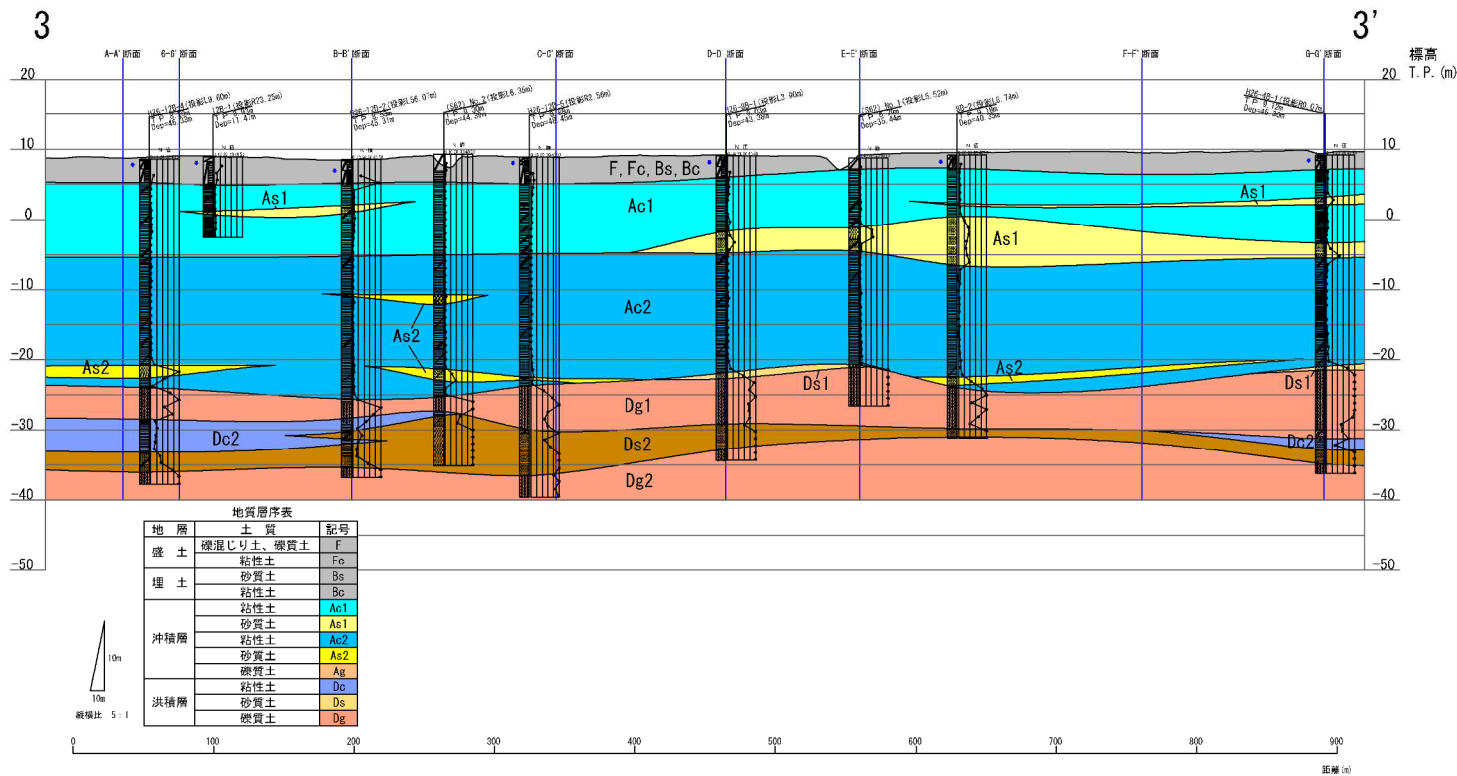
地層層序表・地質想定断面図 (3-3' 断面)
